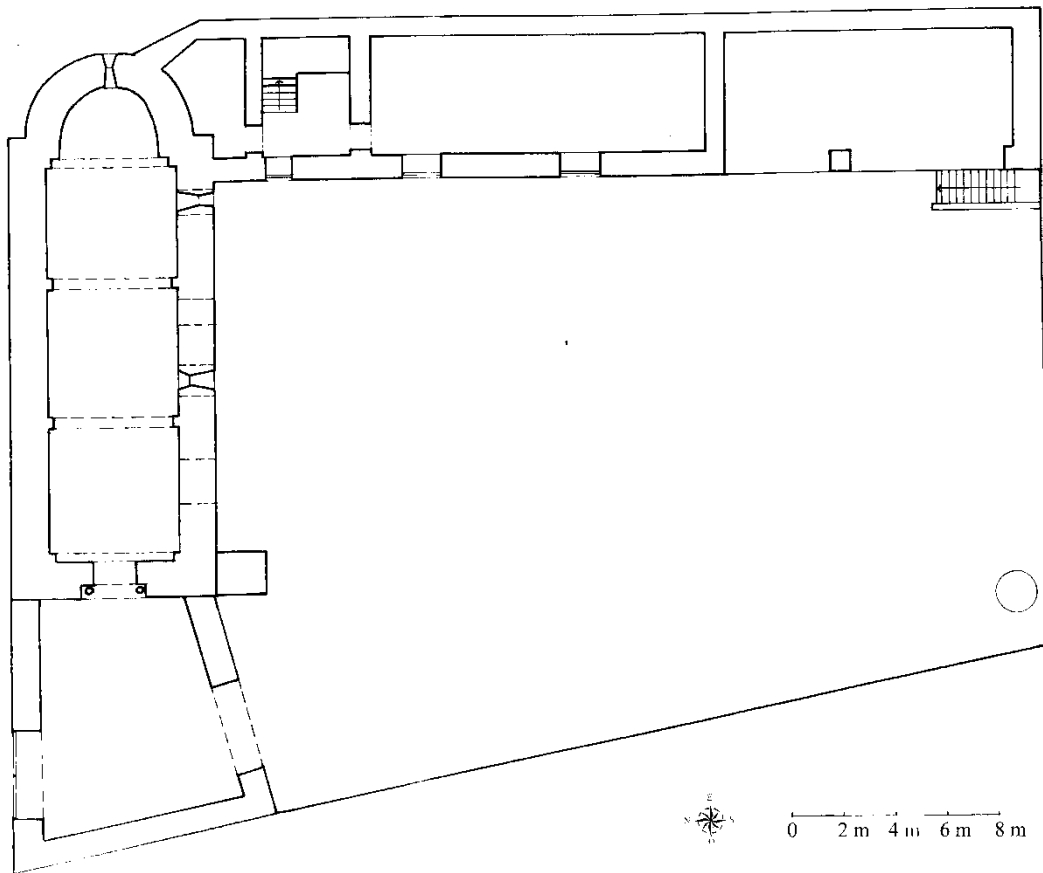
Plan de l'ensemble prieural de Saint-Promasse (SDAP, Alpes-de-Haute-Provence).
